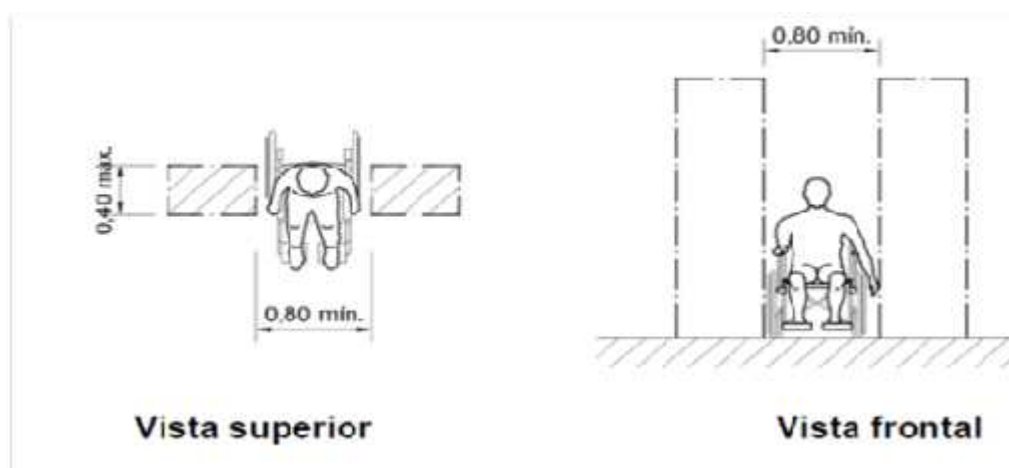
Dimensões padronizadas para cadeiras de rodas
